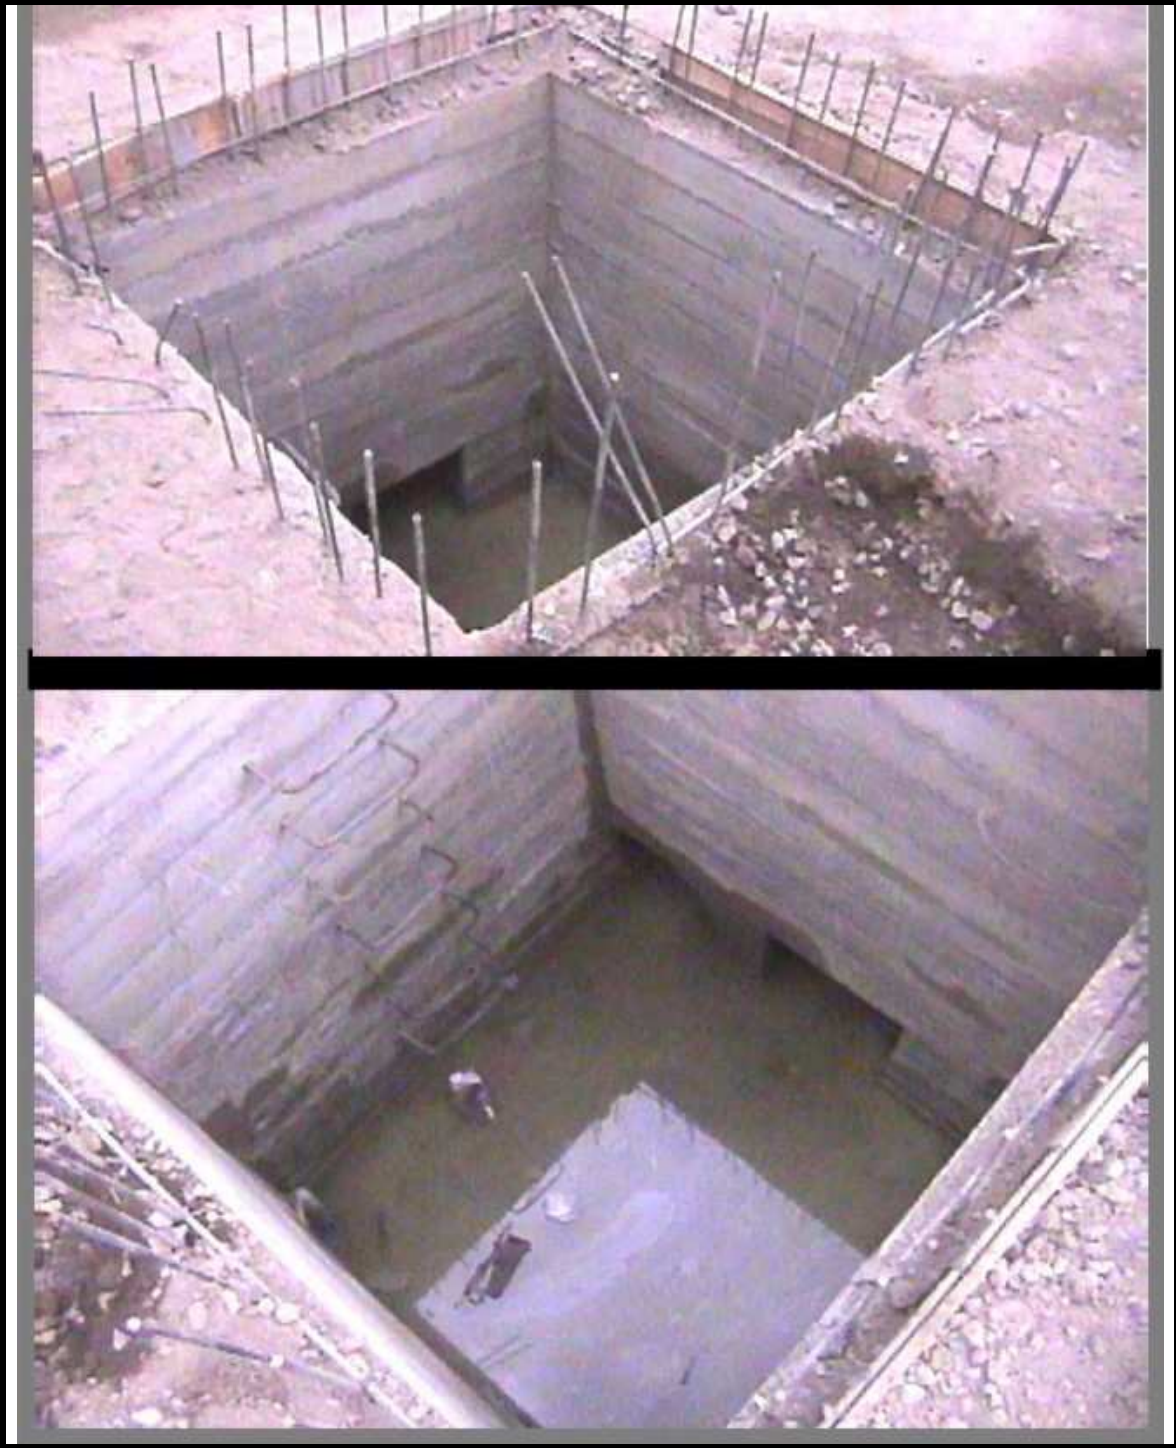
Poso de inspección del Box Coulver, lado izquierdo
